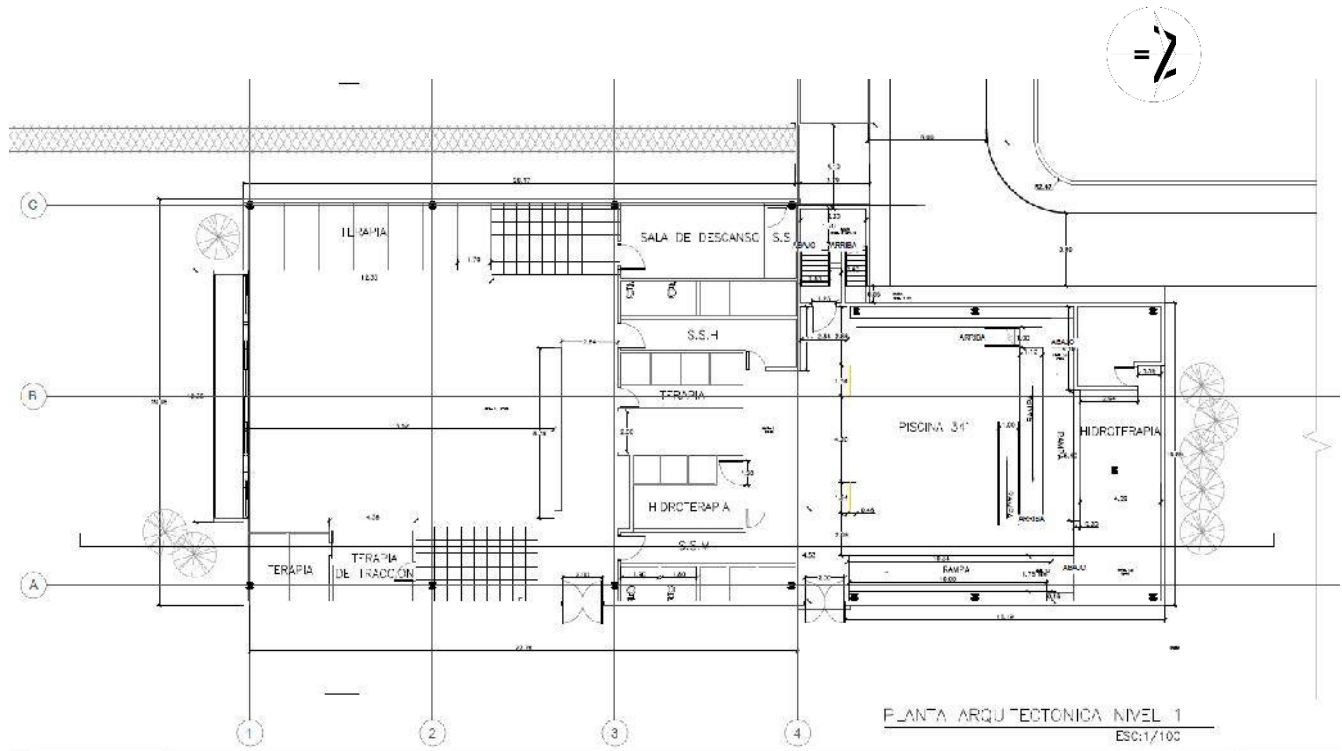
Planta arquitectónica del área de terapia física a intervenir.
